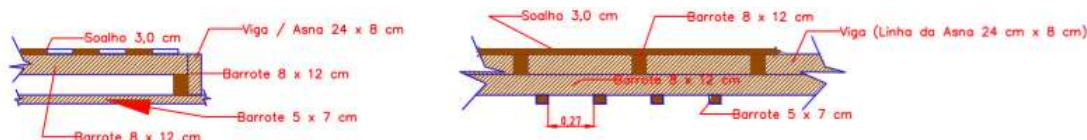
Pormenor do Pavimento e Teto do Desvão da Cobertura (Sótão)
